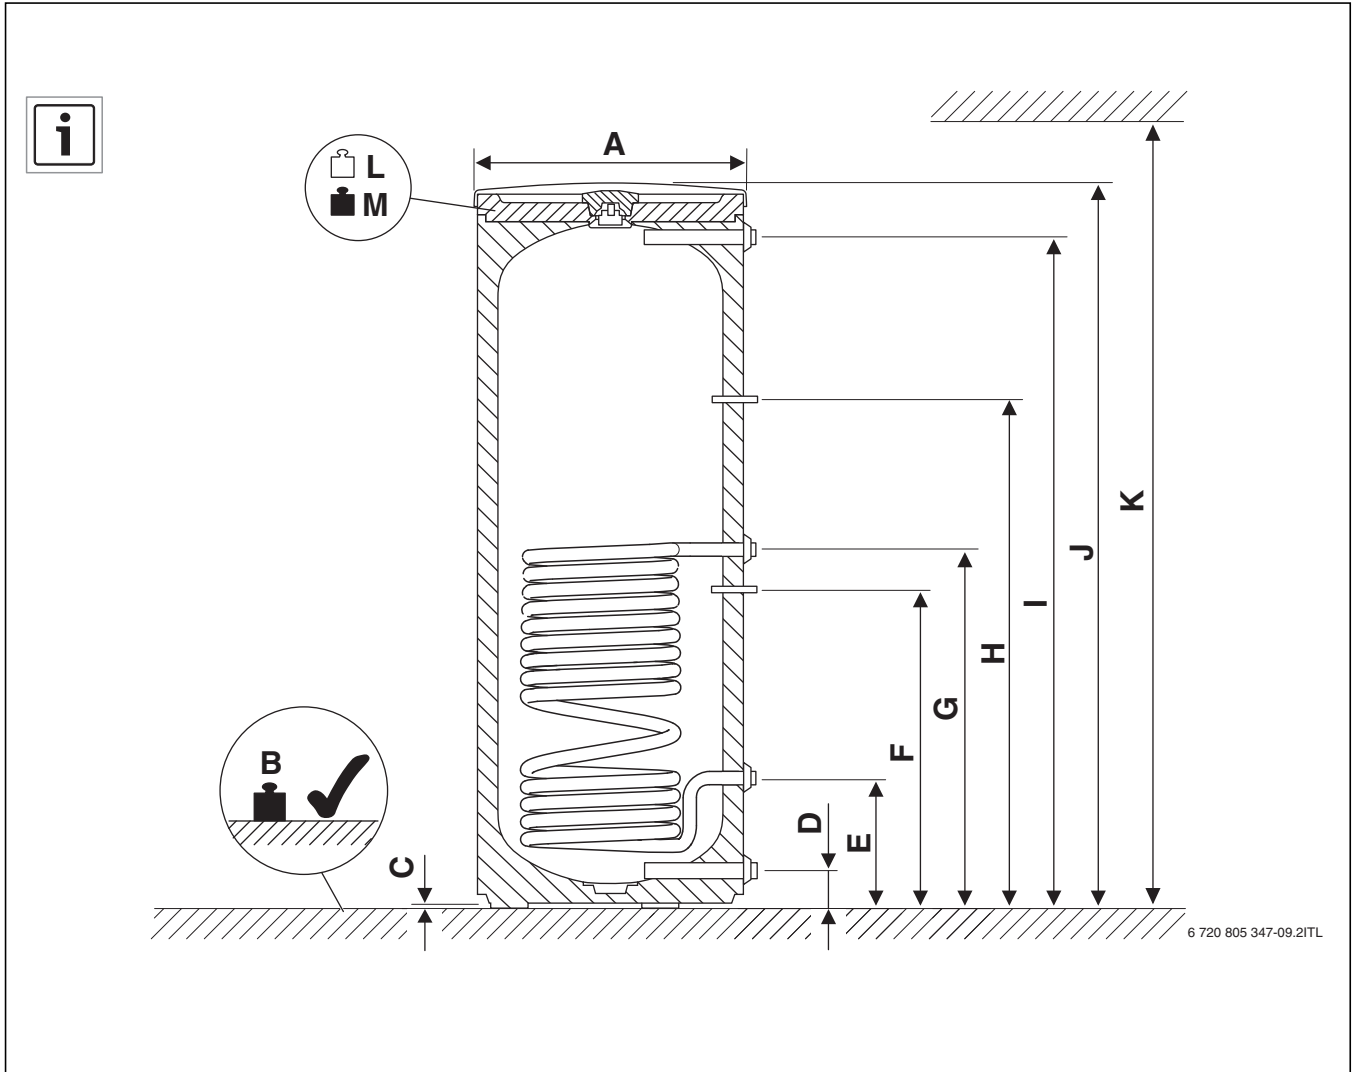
Bau- und Anschlussmaße P 290-5 SHU/P 400-5 SHU
